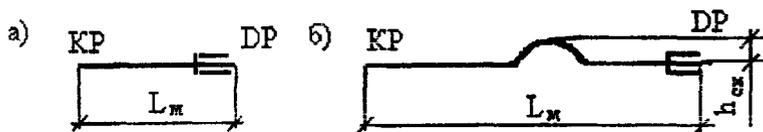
Стандартные детали: а) – сгон; б) – короткая скоба
